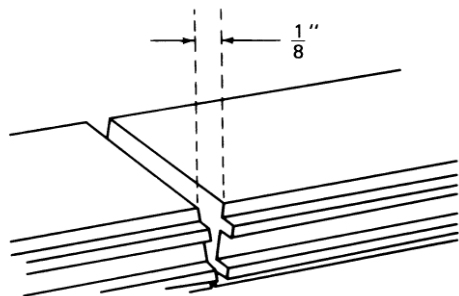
Срез торцов досок обшивки под углом 2° , обеспечивающий прочное соединение досок на лицевой поверхности потолка
